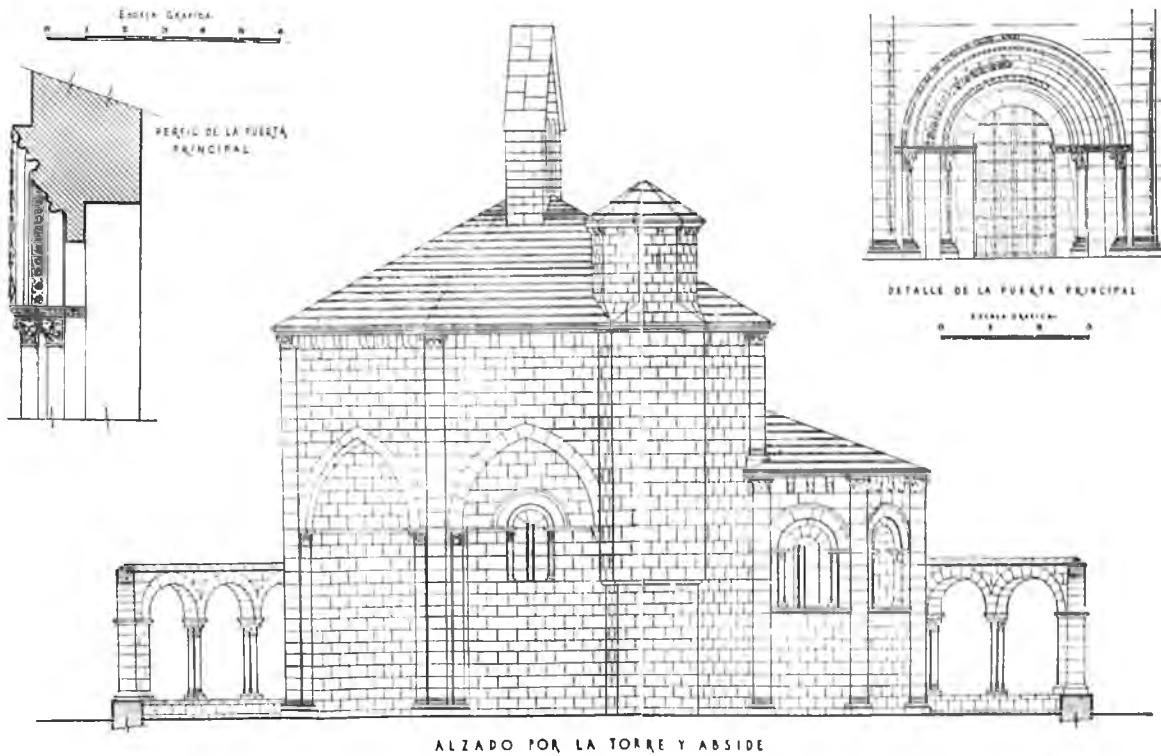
Santa María de Eunate. Alzado Sur y detalles de la portada.
